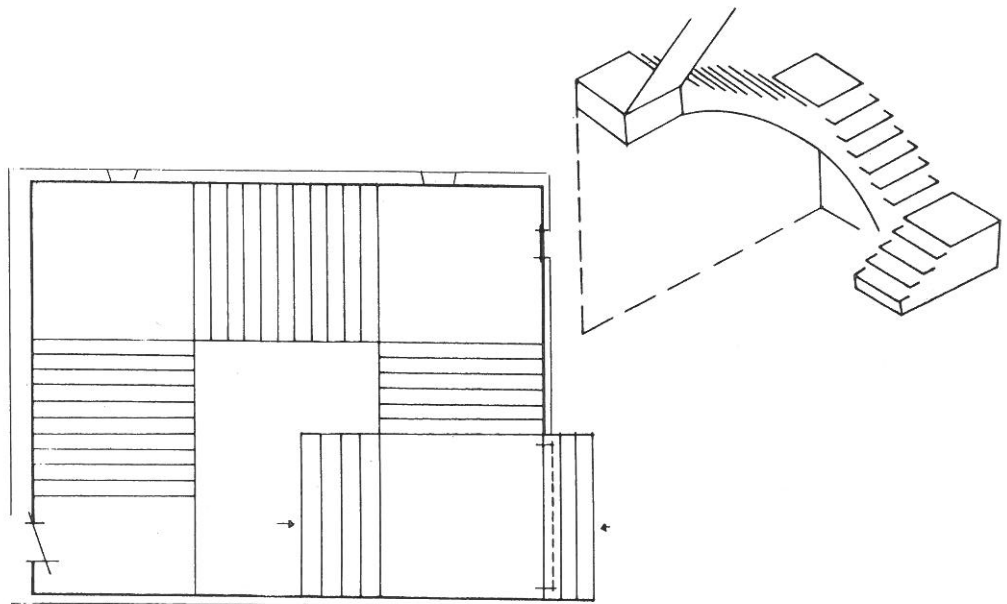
Planta y alzado de la escalera principal de la Colegiata de San Isidoro de León.
